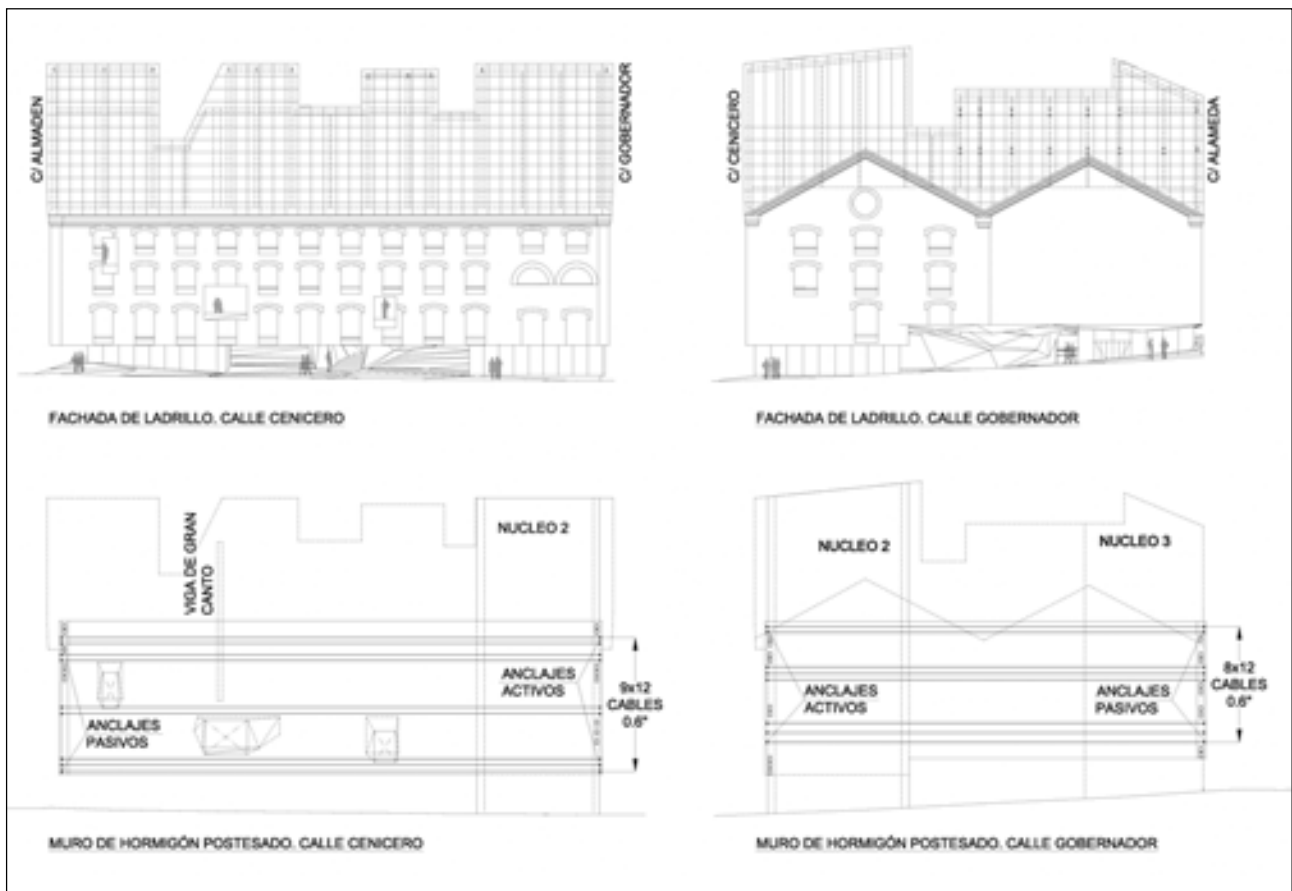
Muro perimetral postesado. Alzados calle Cenicero y calle Gobernador.
